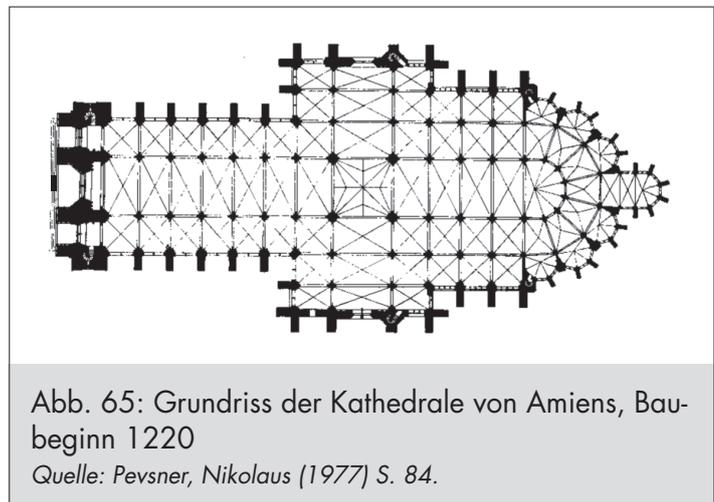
Grundriss der Kathedrale von Amiens, Baubeginn 1220
